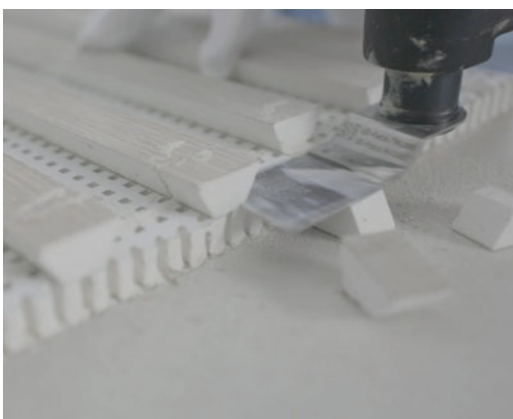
Pour obtenir un bon raccordement des dalles sur les bords des murs, couper les lattes selon la cote souhaitée. Poser les dalles sur les cornières de rive.
